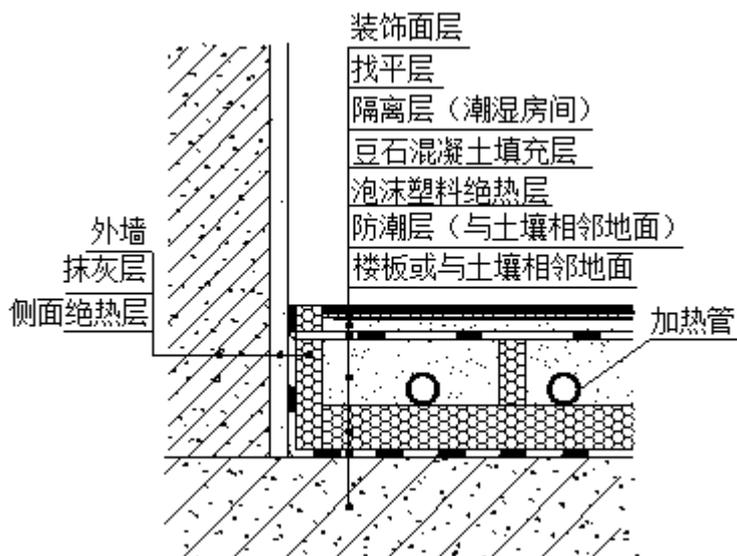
采用泡沫塑料绝热层的混凝土填充式热水供暖地面构造
